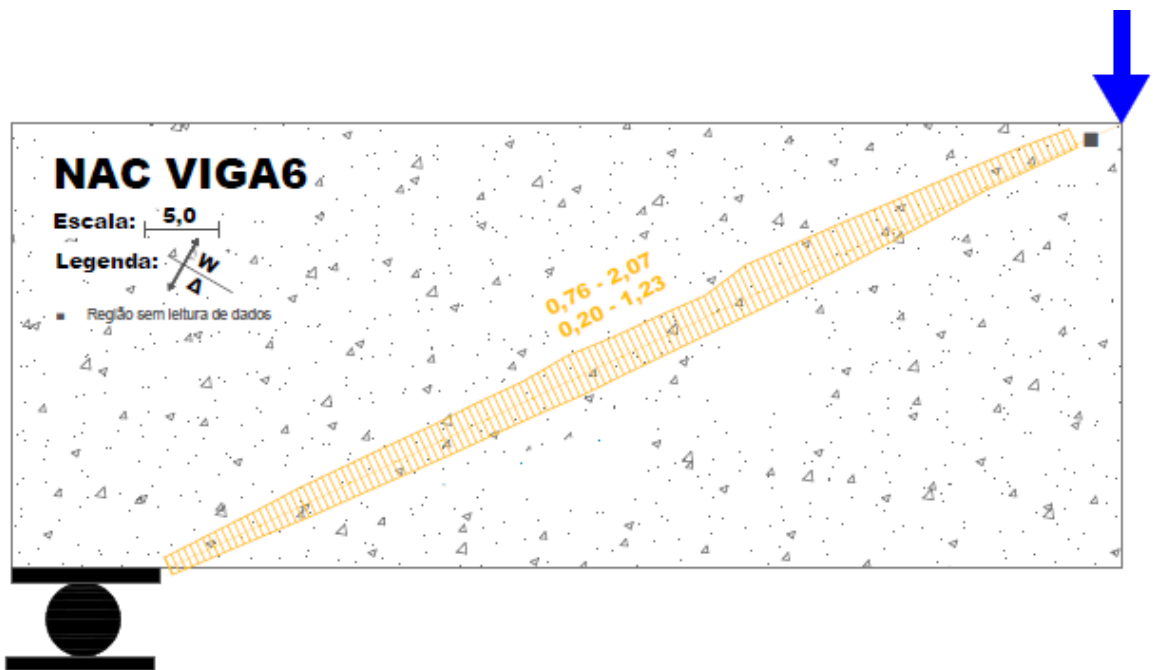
Abertura (w) e deslizamento (Δ) da fissura diagonal crítica da viga NAC-6.
